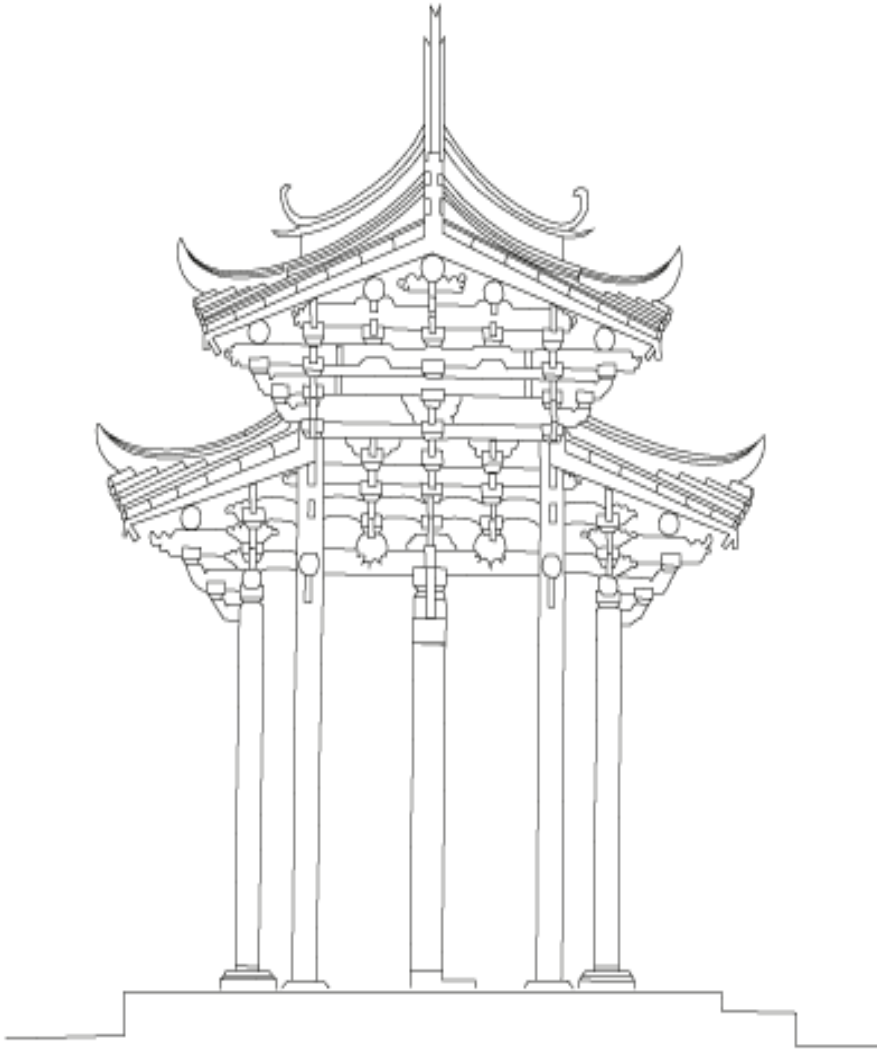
San-men* visto en sección vertical. Imagen redibujada (Han, 1980 Han, 1980. 簡圖重繪於: 漢寶德, 鹿港龍山寺之研究).
